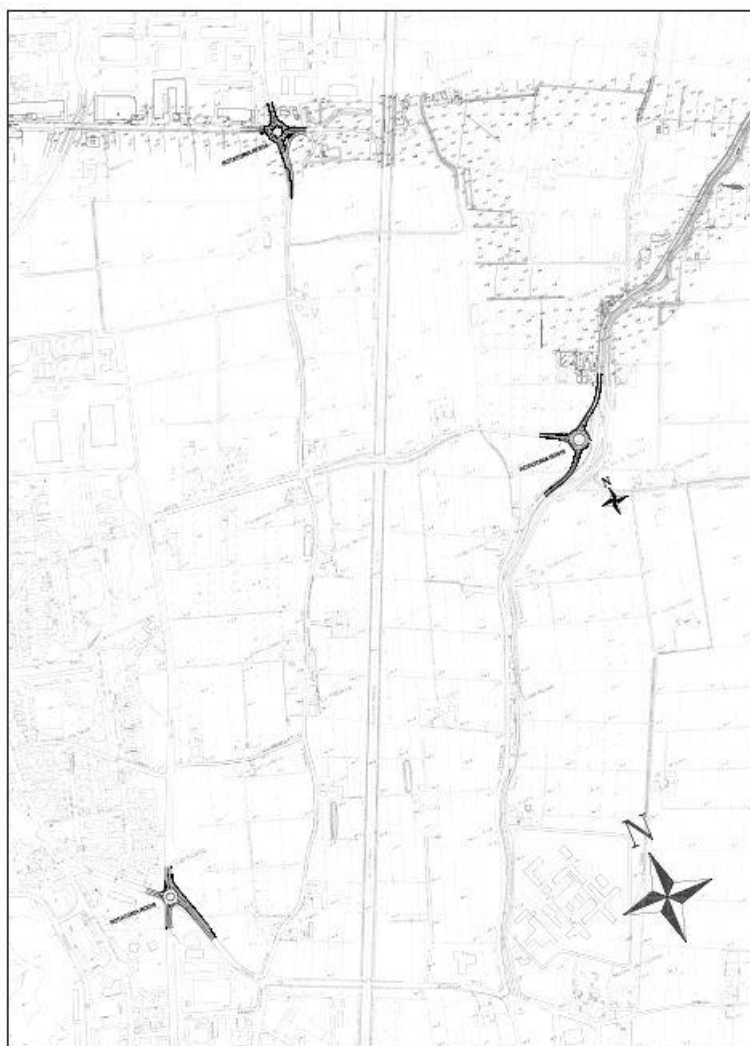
Planimetria dell'area di intervento Tratta D1.
